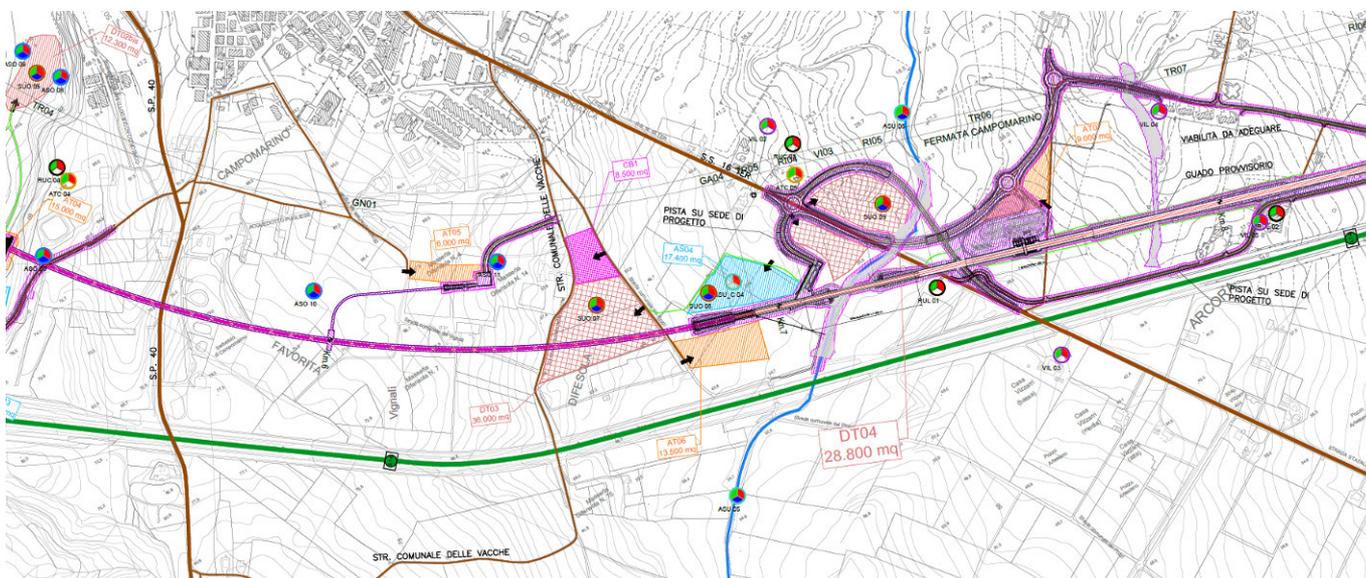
Stralcio Planimetria localizzazione punti di monitoraggio tav 3/9
